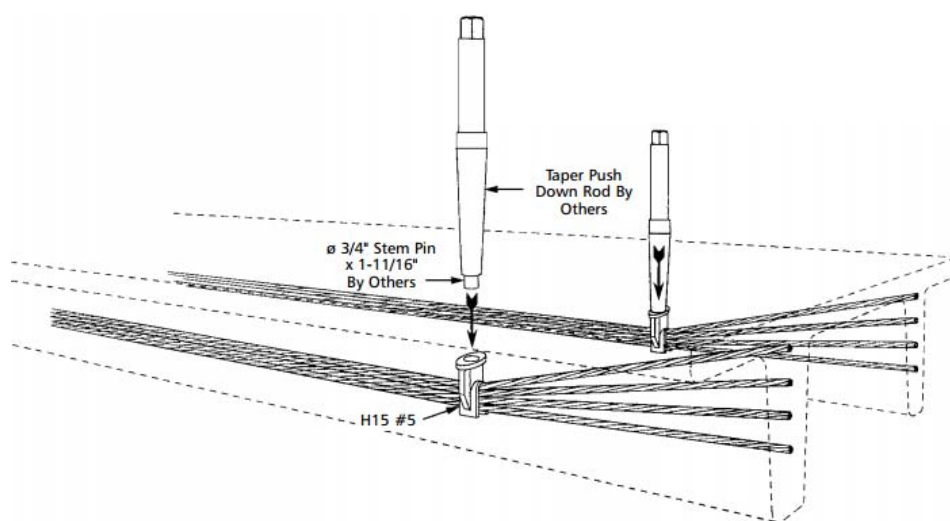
Aplicación de las anclas depresoras multitorón. (Dayton Superior; Concrete Prestressing Handbook)
